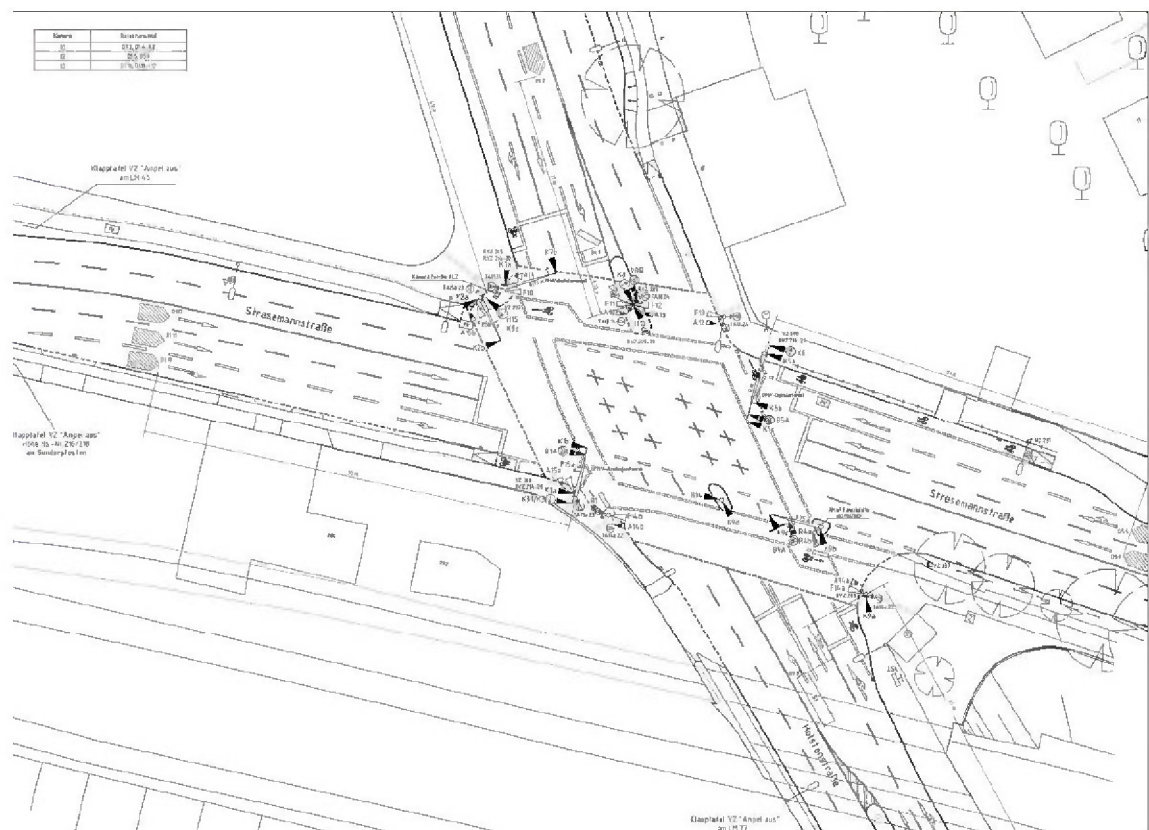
Signallageplan Stresemannstraße/Kieler Straße – Bestand (12/7-04-07/02e)
